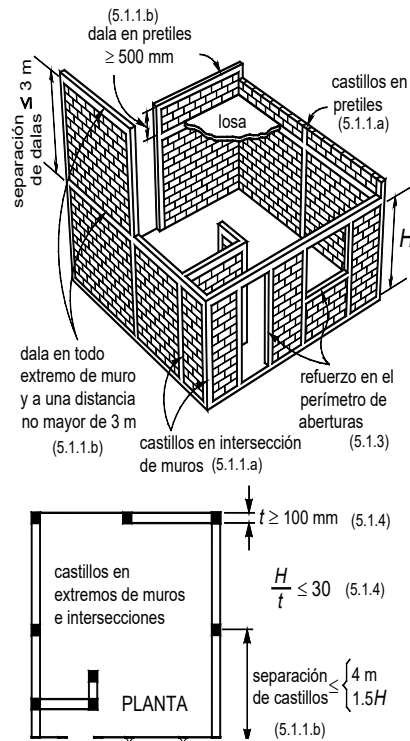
REQUISITOS PARA MAMPOSTERÍA CONFINADA
